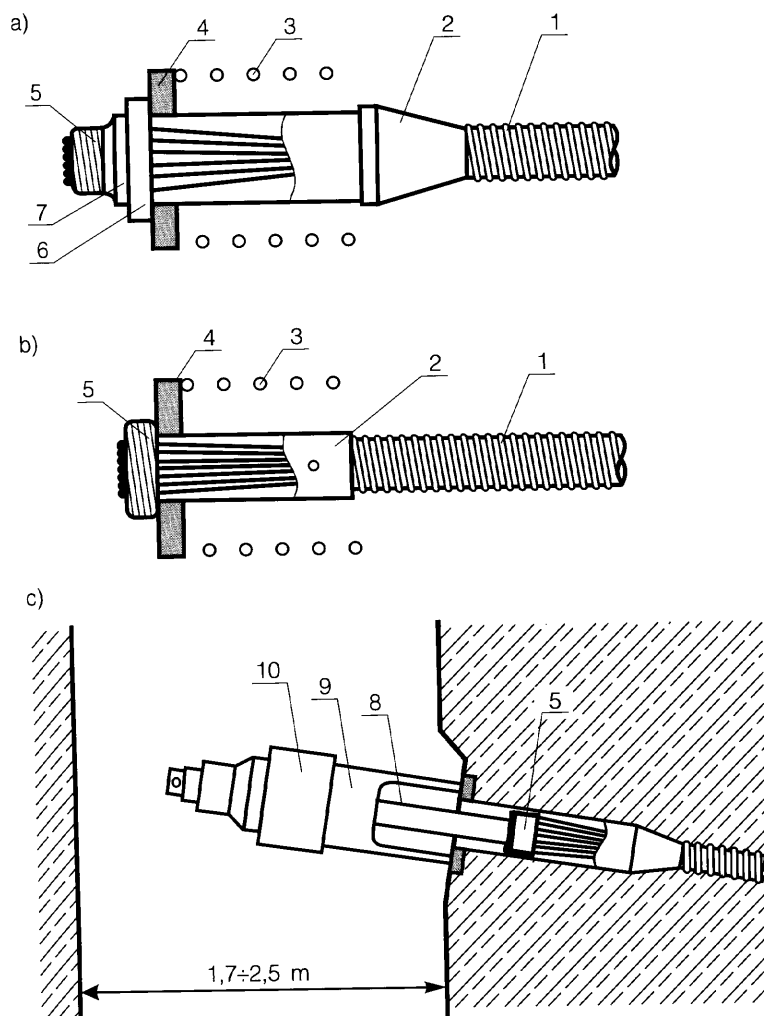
Krajowa modyfikacja zakotwienia *Freyssineta*: a) stalowy blok kotwiący, b) stalowy stożek poprzecznie rowkowany, c) usytuowanie zakotwień na czole elementu
